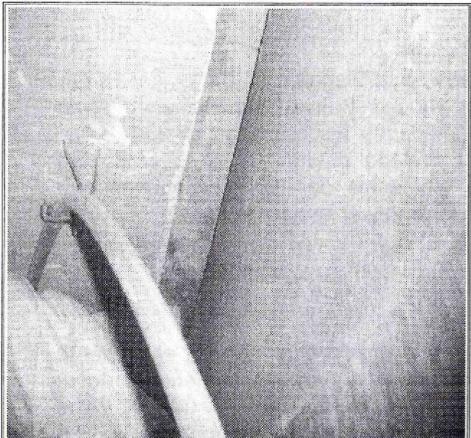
Vista manguera usada como media de drenaje de la excavación en la columna
